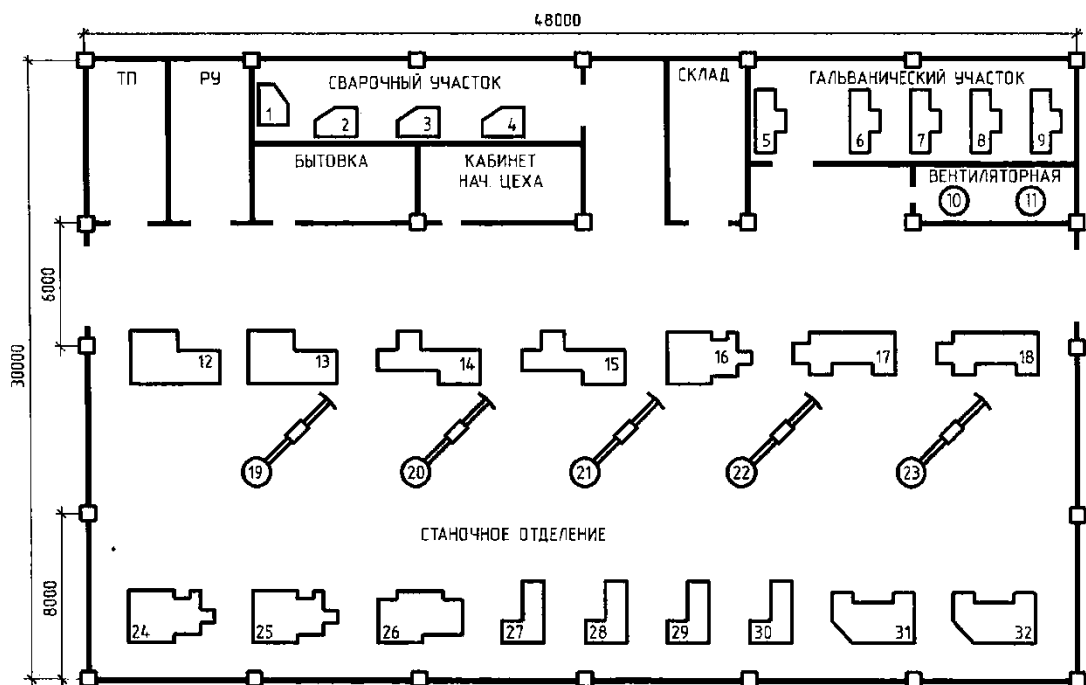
План расположения ЭО цеха обработки корпусных деталей
